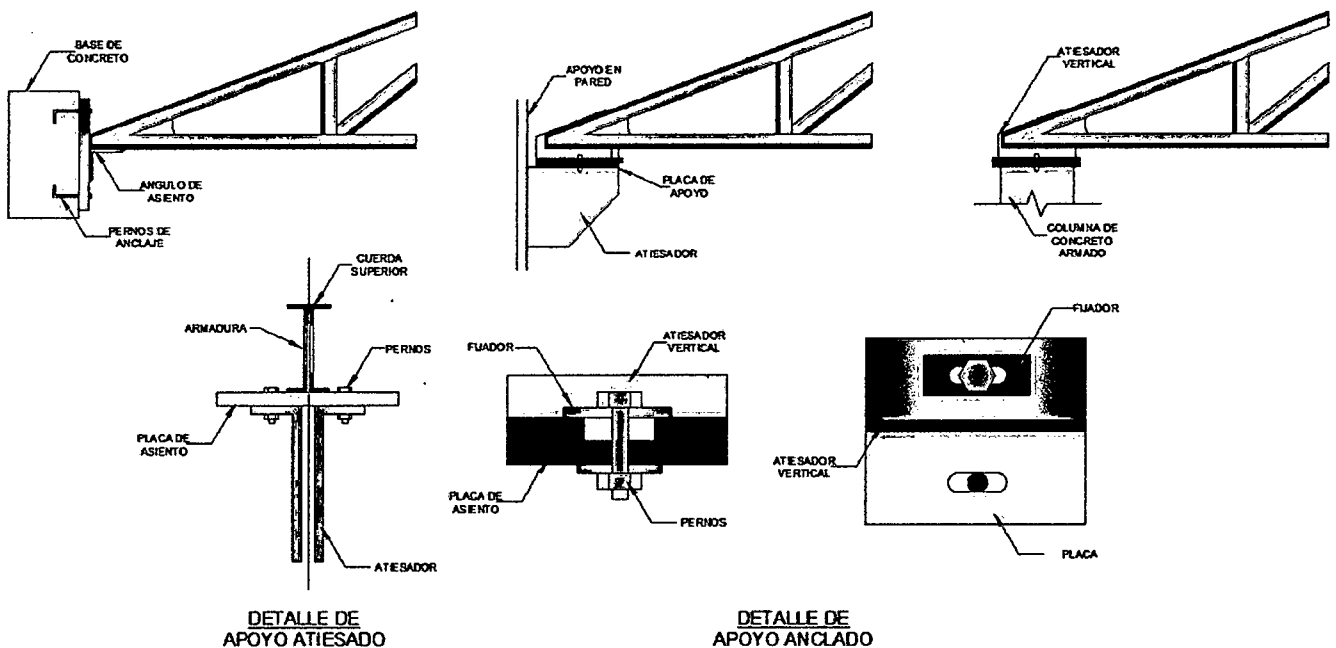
81: Tipos de apoyos anclado y atiesado en concreto y acero.
